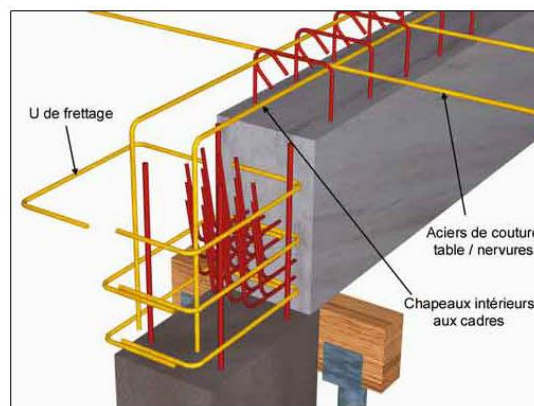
assemblage poteau-poutre source : <https://www.seac-gf.fr/>
